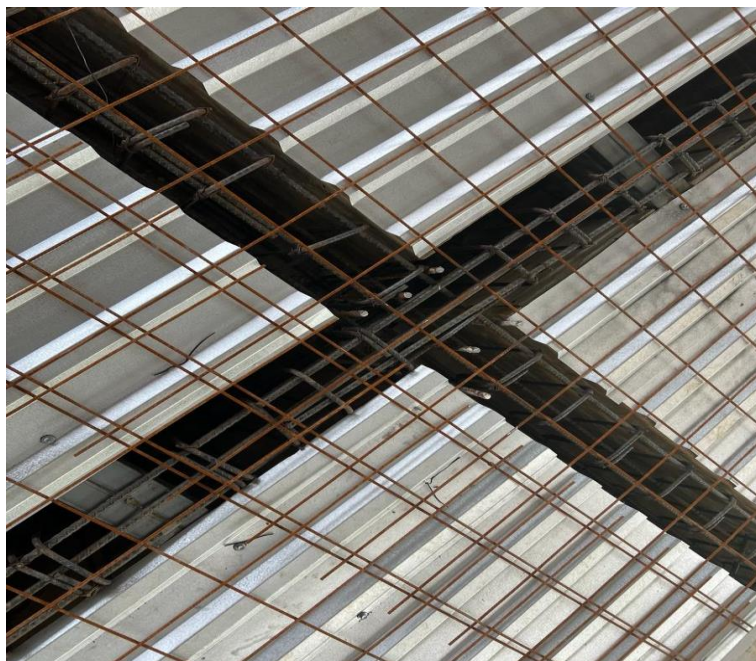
Detalle de mallas, vigas y láminas para fundición monolítica
